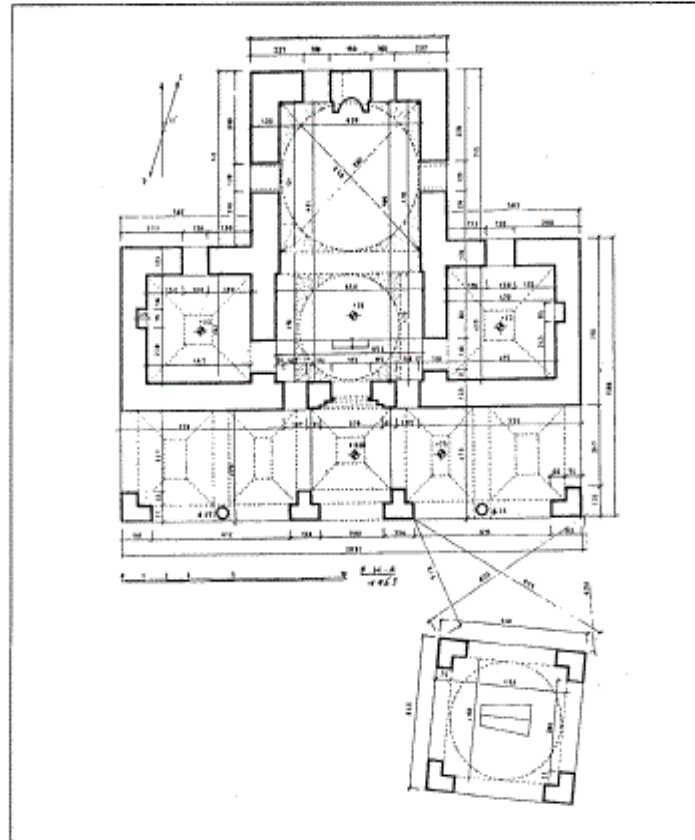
مسقط أفقي وقطاع لعمارت غازي أورنوس بك في كوموتيني باليونان
